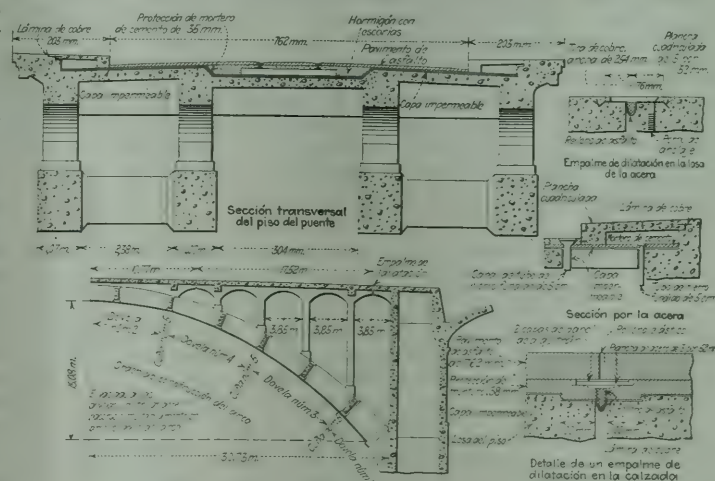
DETALLES DE UN ARCO DE PUENTE DE HORMIGÓN ARMADO MOSTRANDO LOS EMPALMES DE DILATACIÓN IMPERMEABLES
